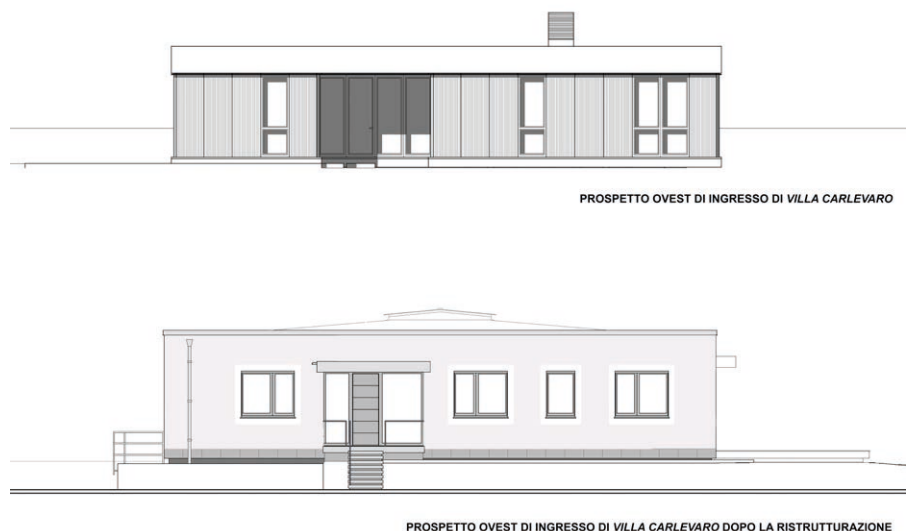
Prospetto ovest di ingresso di Villa Carlevaro, prima e dopo la ristrutturazione. Disegno dell'autrice
